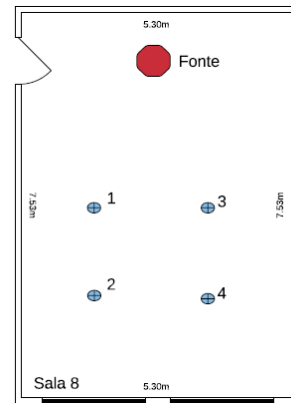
Planta baixa, com indicação do posicionamento da fonte e receptores, da Sala 8. (Os autores, 2018).
